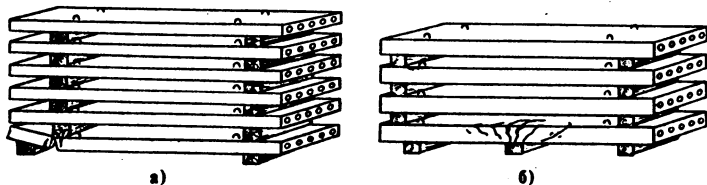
Разрушение железобетонных плит при неправильном складировании:
